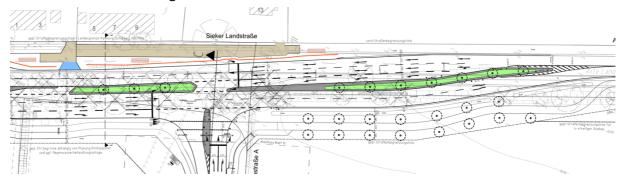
Geplanter Ausbau Kreuzungsbereich L 222 / neue Gewerbeerschließung, wfw nord consult, Hamburg Januar 2018, ohne Maßstab (vgl. Anlage 3).
